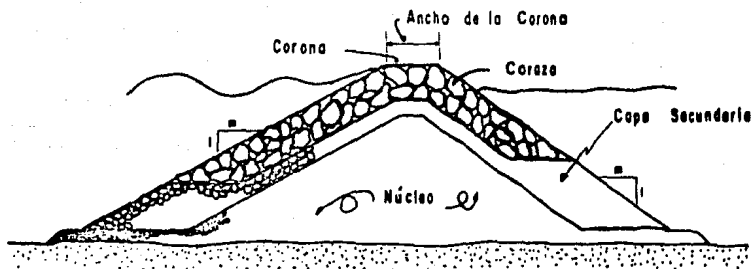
OBRAS DE TALUD. SECCION TIPO.
